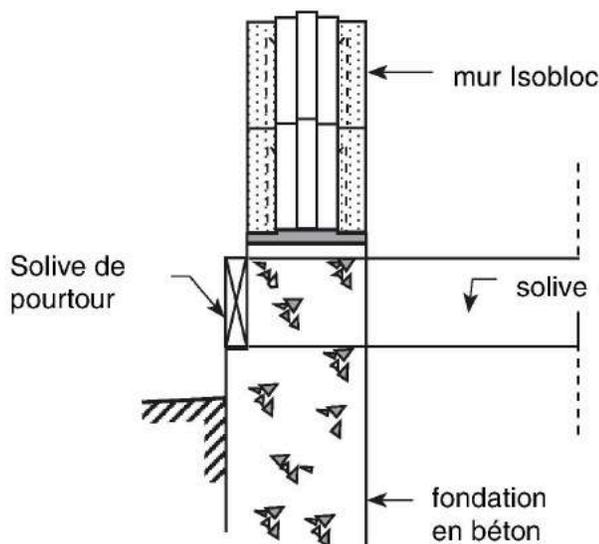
« Isobloc » sur fondation en béton avec solives enchâssées
